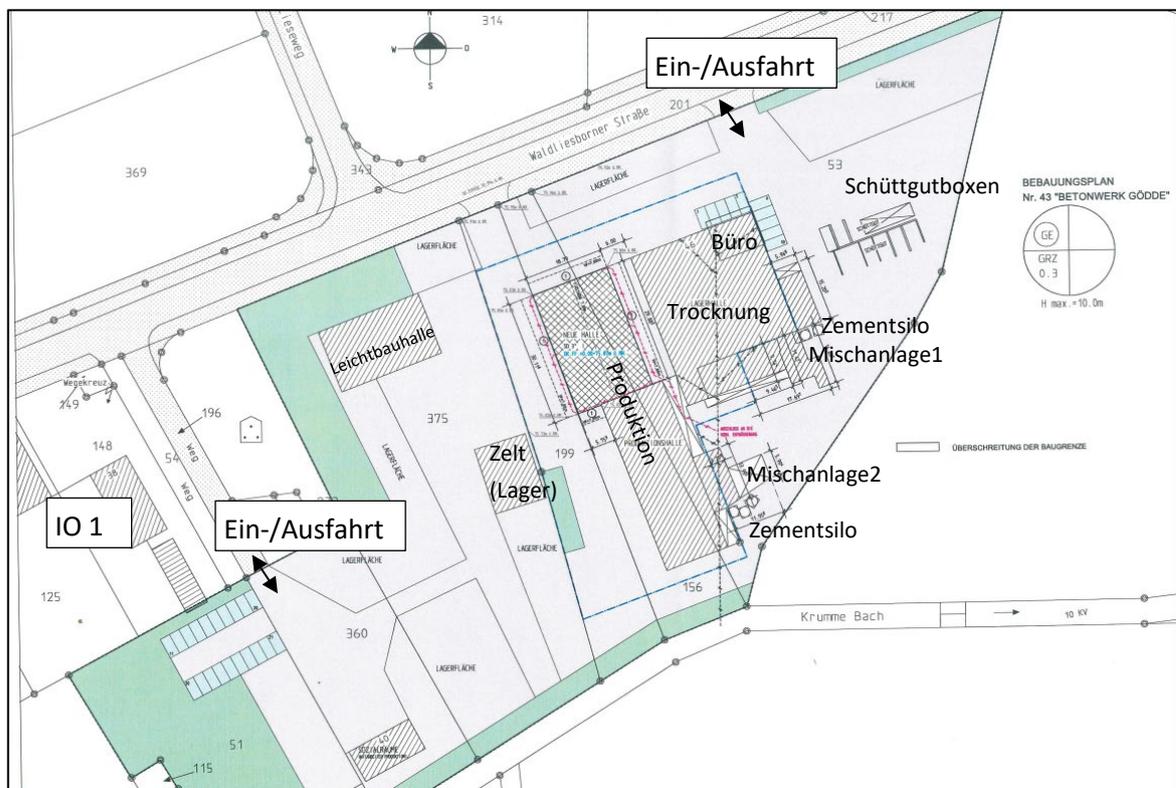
Lageplan, Auszug aus [19] (ohne Maßstab)
